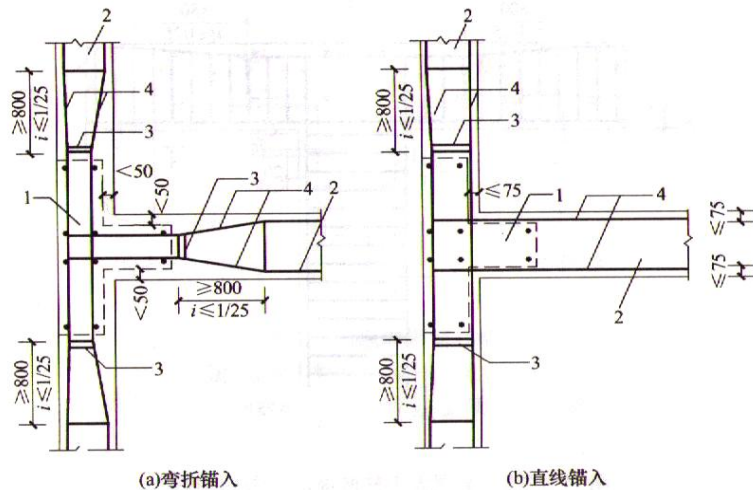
框架梁纵向钢筋锚入节点区的构造
